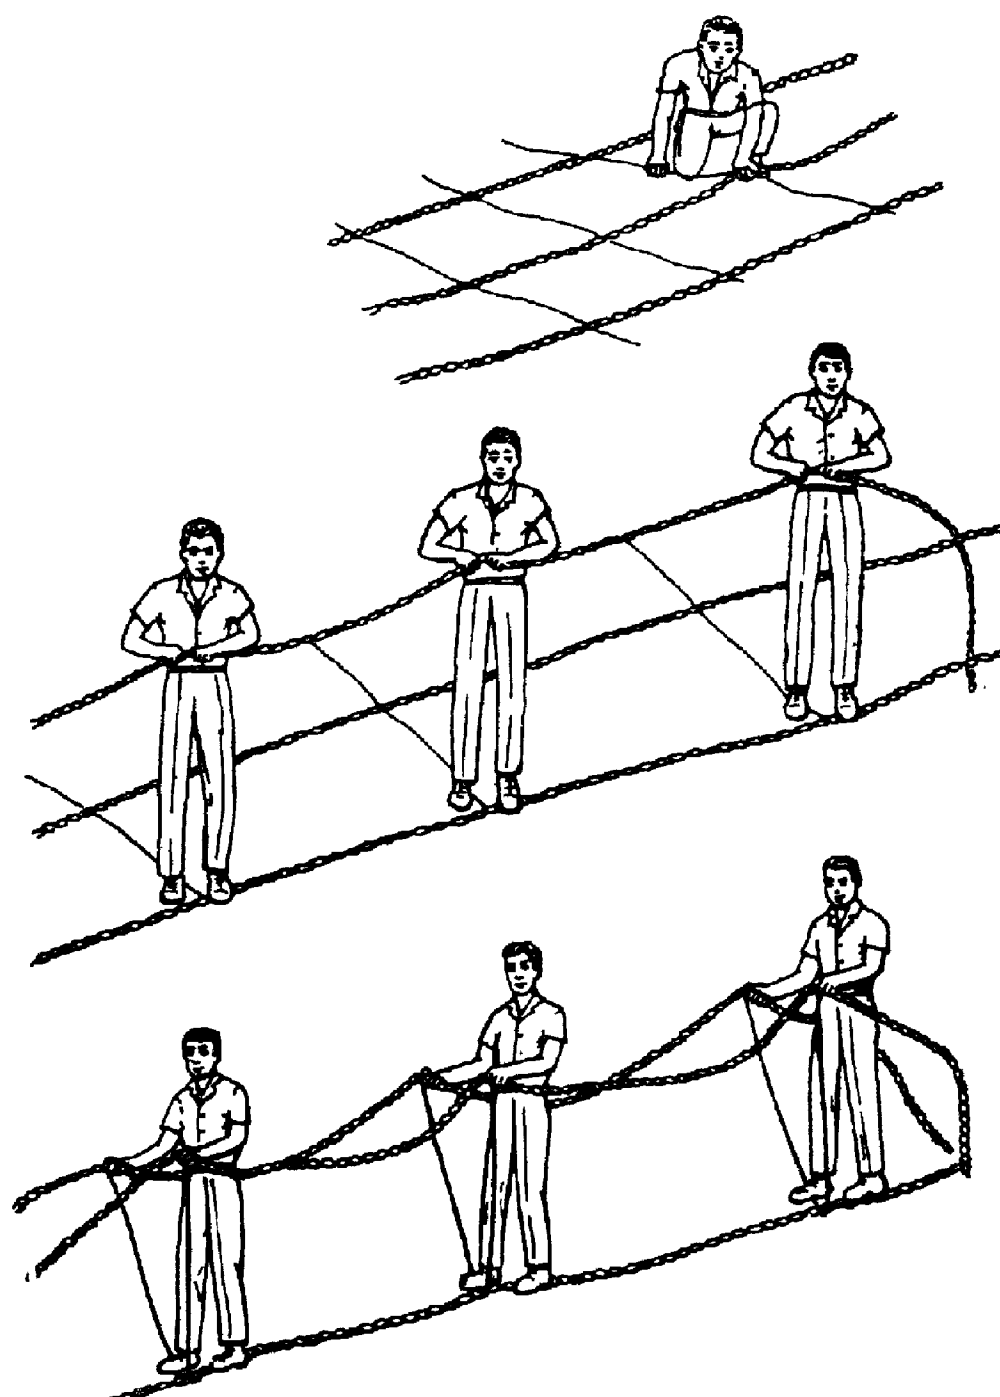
Puente de tres cables. Procedimiento recomendado para la construcción.
